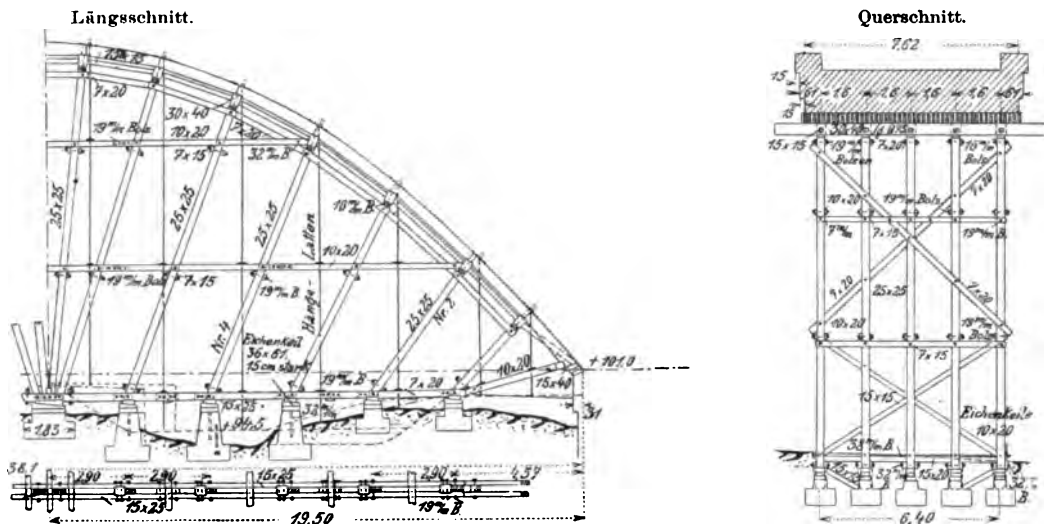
Lehrgerüst der Brücke über den Piney Creek.
